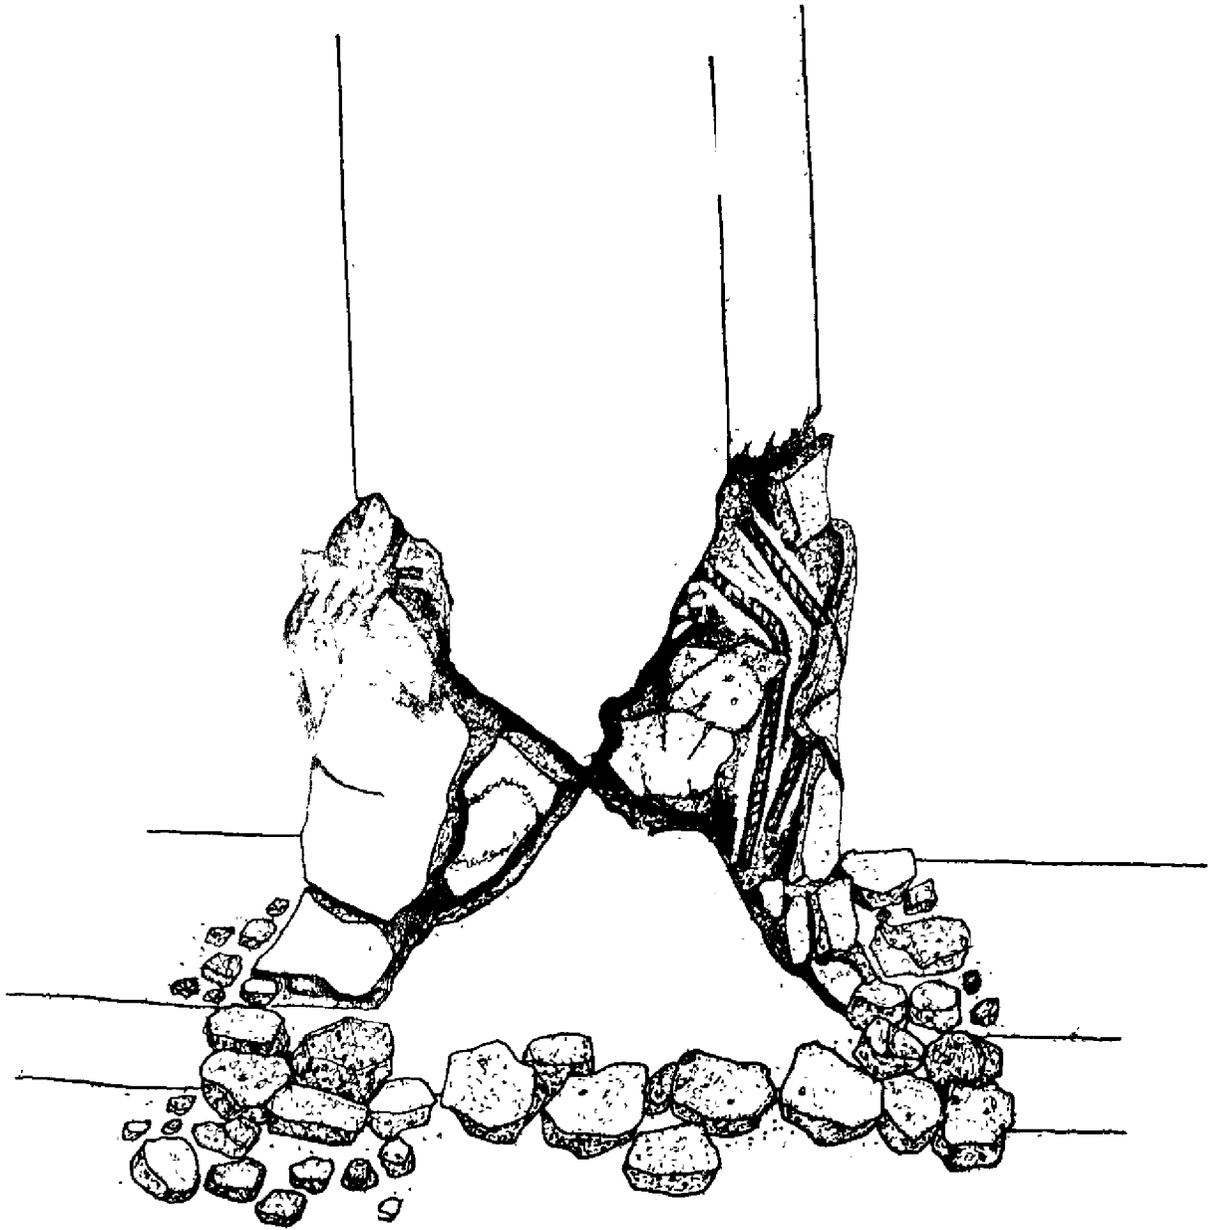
Falla típica del hormigón debido a la falta de armadura transversal (estribos) de confinamiento
